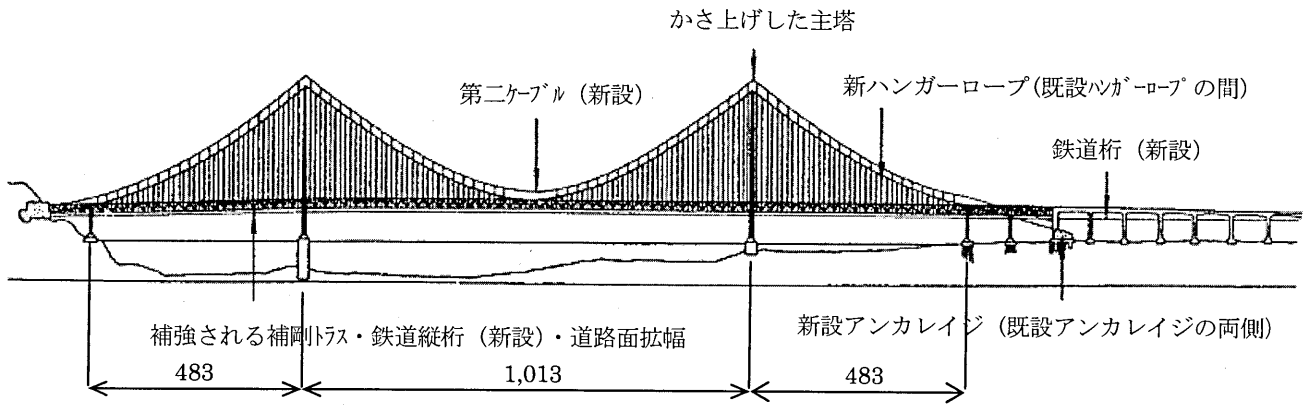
4月25日橋の側面図(寸法単位:m)
